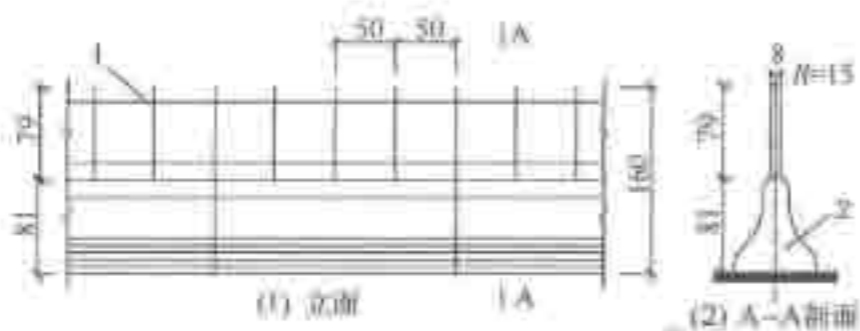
设置于混凝土护栏上的防眩板构造 (尺寸单位: cm)
